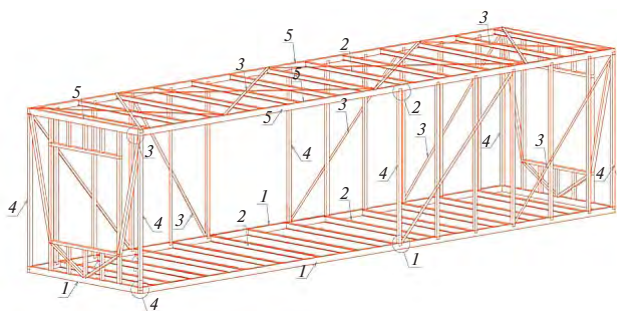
Схема основных элементов каркаса модулей: 1 – основные несущие балки основания блок-модуля (продольная, поперечная) выполняются из профилированной трубы прямоугольного сечения, ходовое сечение 200×100 мм, толщина стенки подбирается по расчету; 2 – поперечные второстепенные балки основания пола модуля и перекрытия модуля выполняются из профилированного двутавра № 14–16, ходовой шаг 50–60 см. Шаг, номер двутавра подбираются по расчету в зависимости от нагрузки на полы; 3 – горизонтальные и вертикальные связи модулей для создания пространственной жесткости каркаса выполняются из полосного металла; 4 – вертикальные несущие стойки каркаса выполняются из профилированной трубы квадратного и прямоугольного сечений; 5 – основные несущие балки перекрытия блок-модуля (продольная, поперечная) выполняются из профилированной трубы прямоугольного сечения
